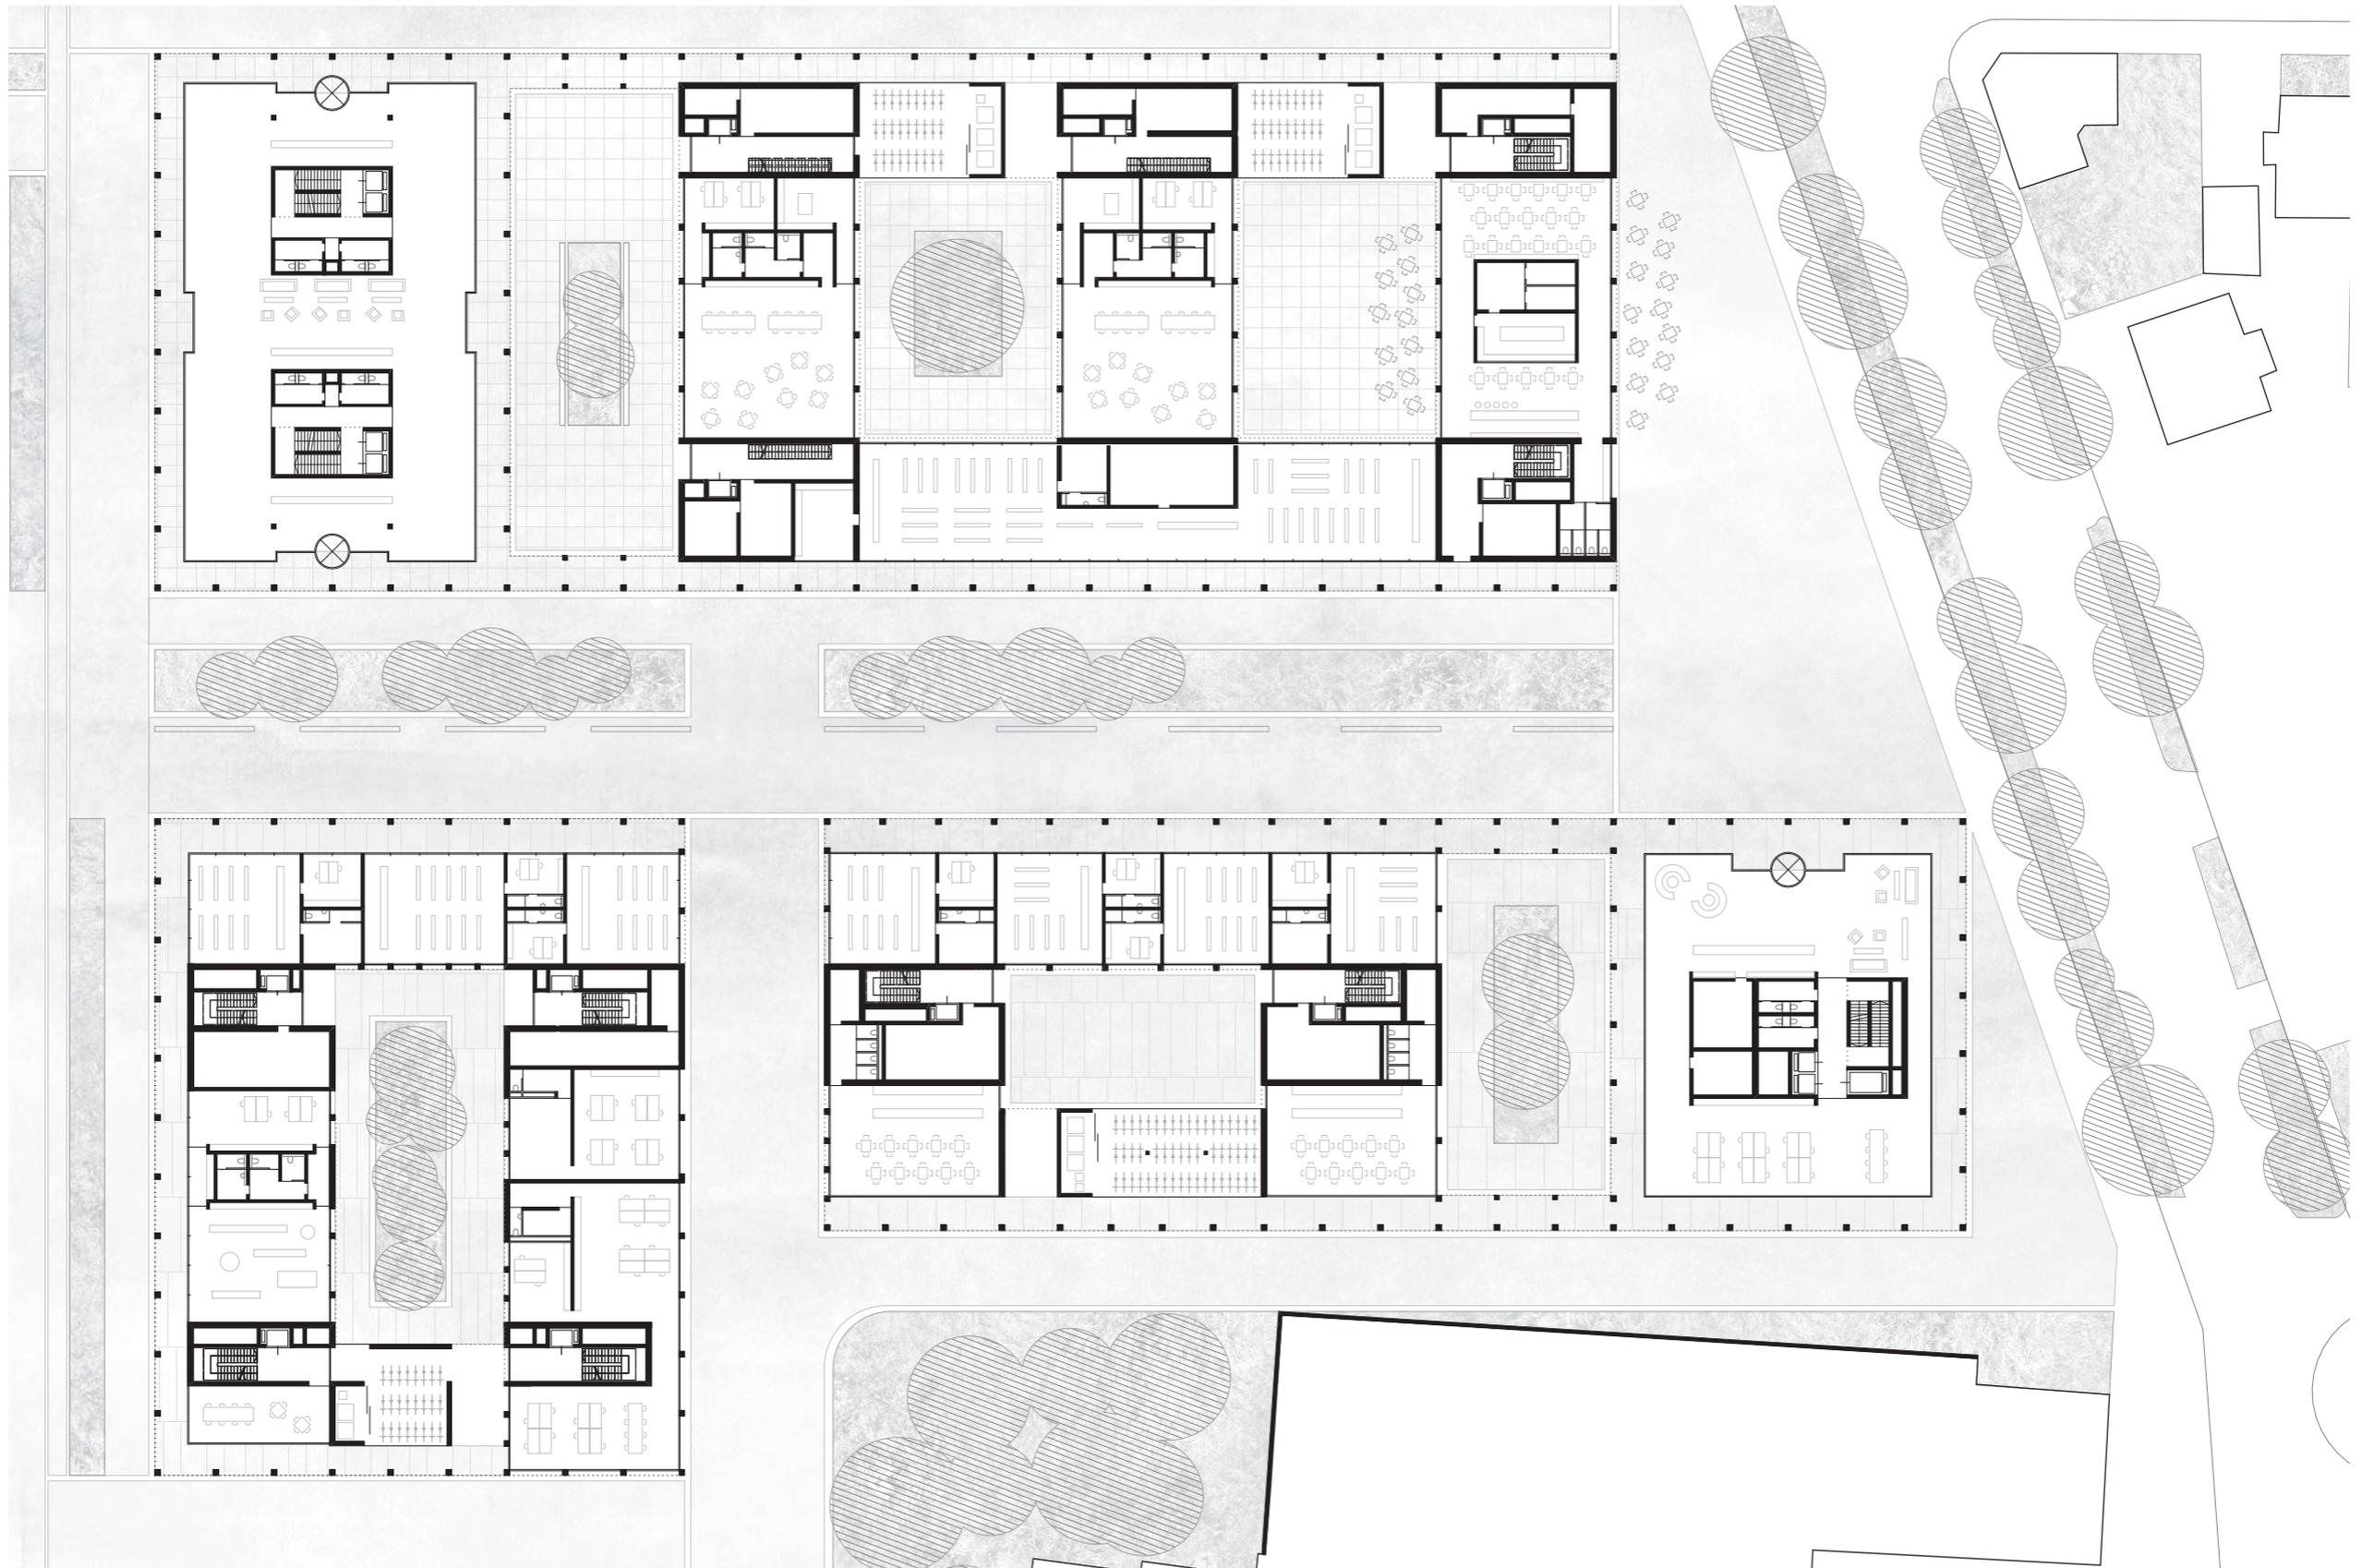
Grundriss Erdgeschoss, Ausschnitt Ost
